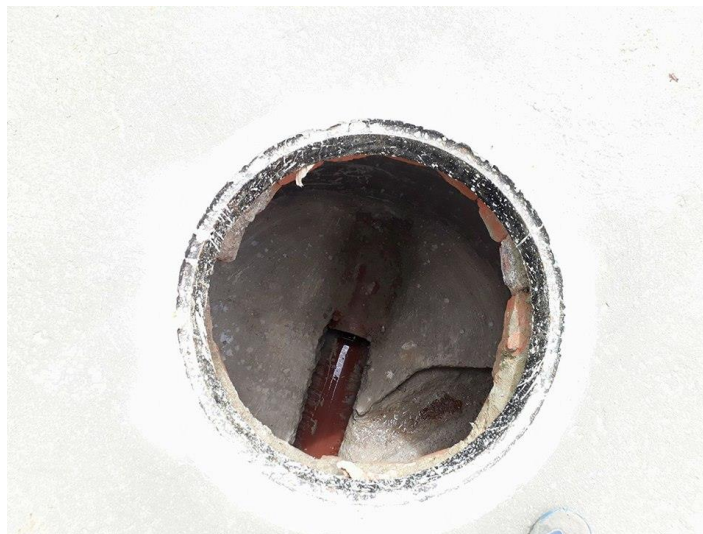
Colector Principal donde se requería conectar la nueva red de alcantarillado. Fuente: Autor.
